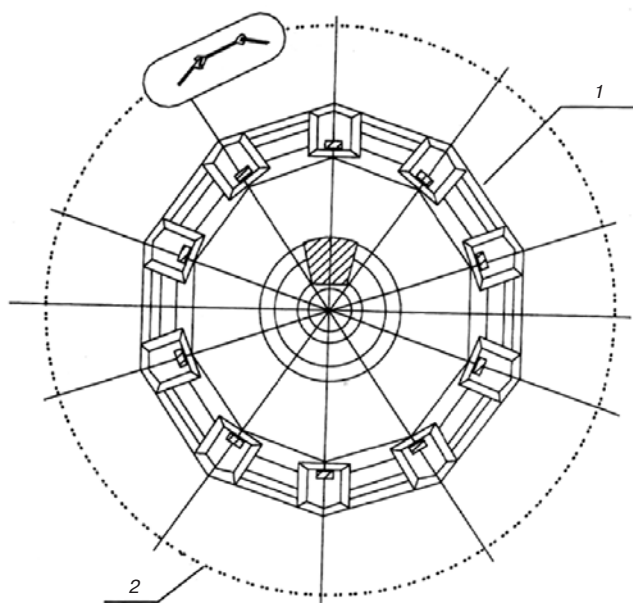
Усиленный вариант главного фундамента: 1 — кольцевая десятигранная плита; 2 — стенка из стального шпунта
